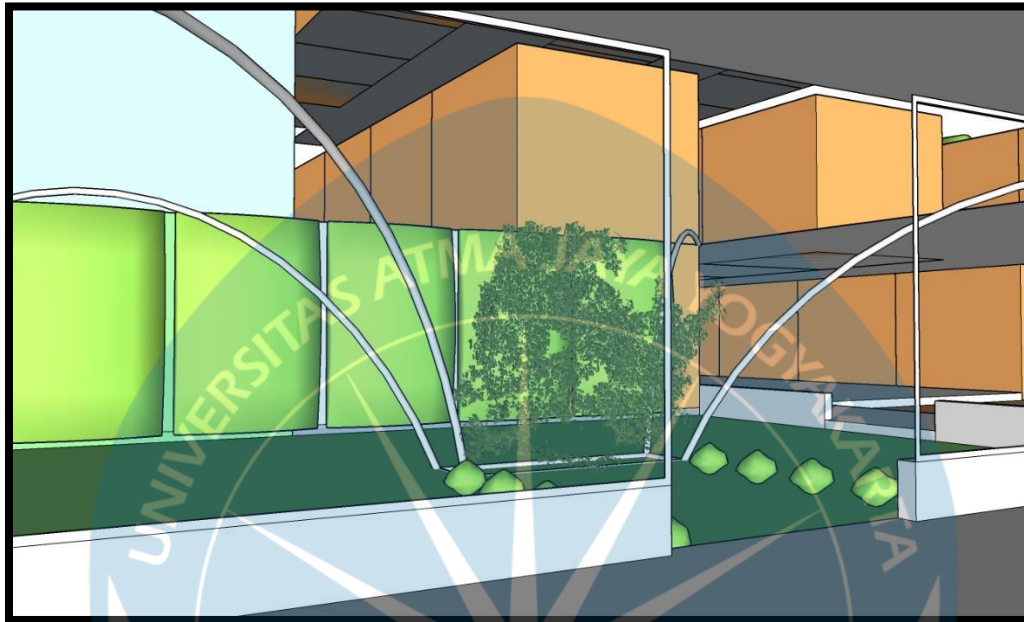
Konsep Penekanan Desain Ruang Rawat jalan
